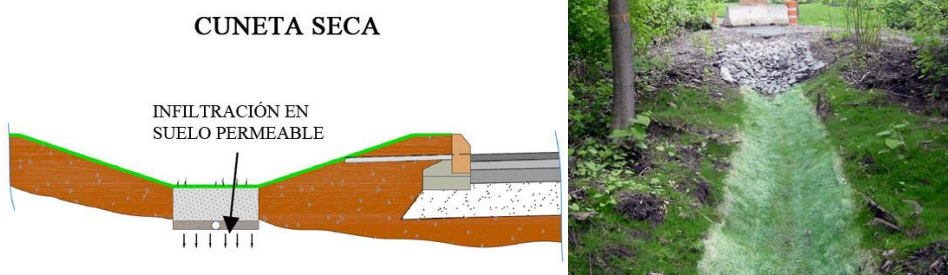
Cuneta seca. Izquierda: sección tipo. Derecha: ejemplo de aplicación.
